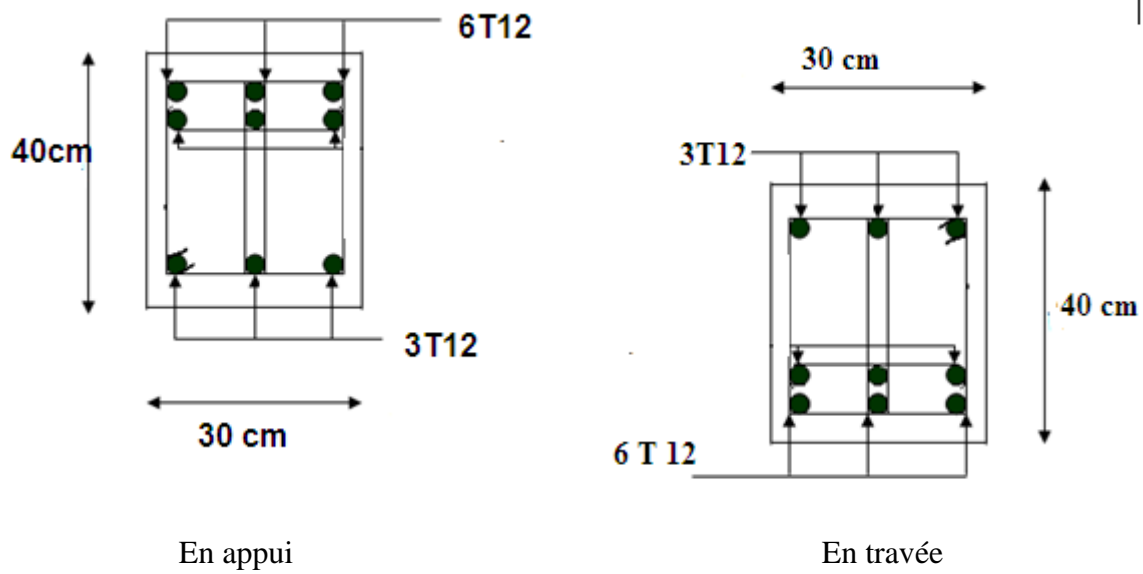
Ferrailage des poutres secondaire (30x40)
